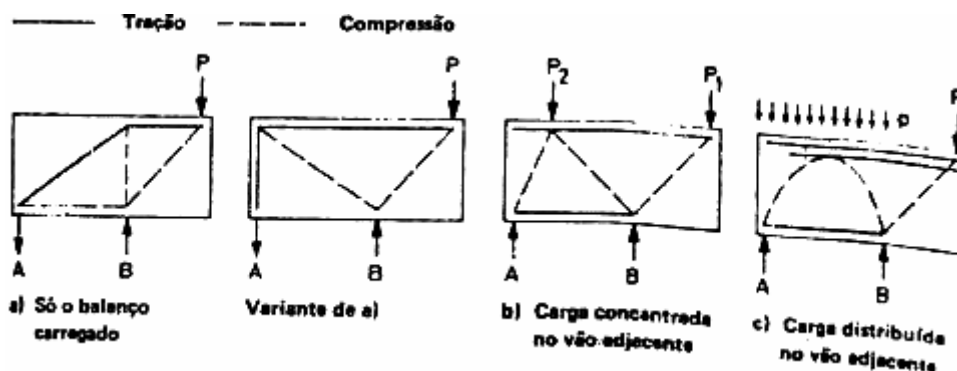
Desenvolvimento esquemático de forças de paredes em consola como ponto de partida para a colocação de armadura
